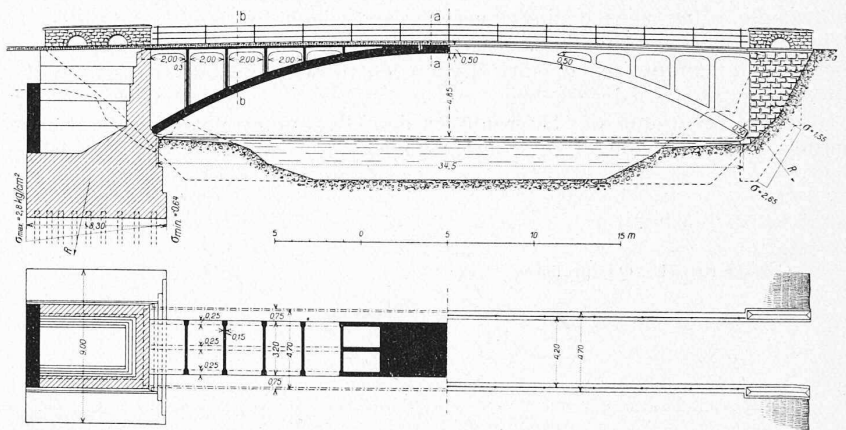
Längsschnitt und Ansicht, Horizontalschnitt und Draufsicht der Glennerbrücke. — Masstab 1 : 400.
